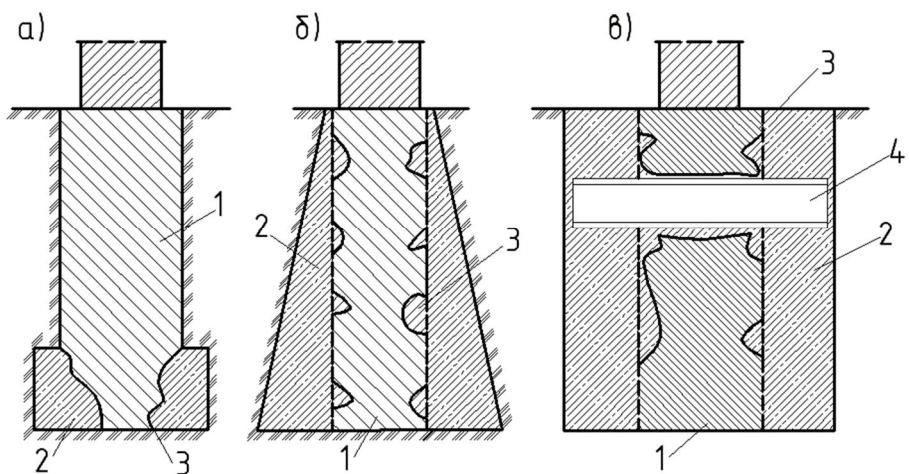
Усиление ленточных фундаментов бетонными обоймами:
